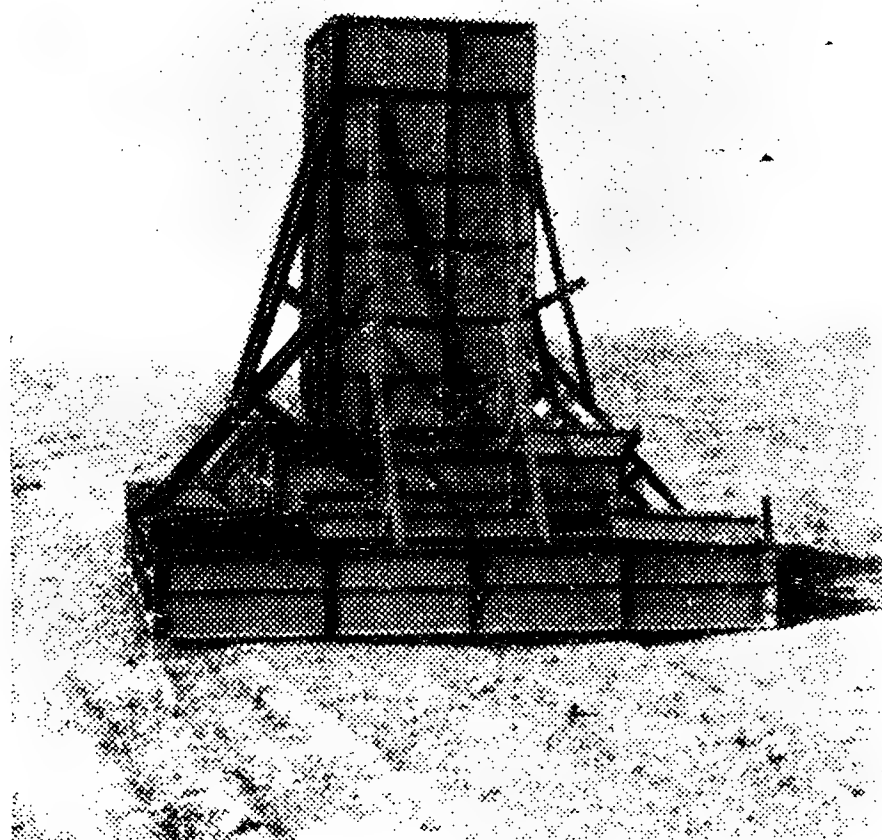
Опалубка монолитного фундамента, собранная из инвентарных щитов
